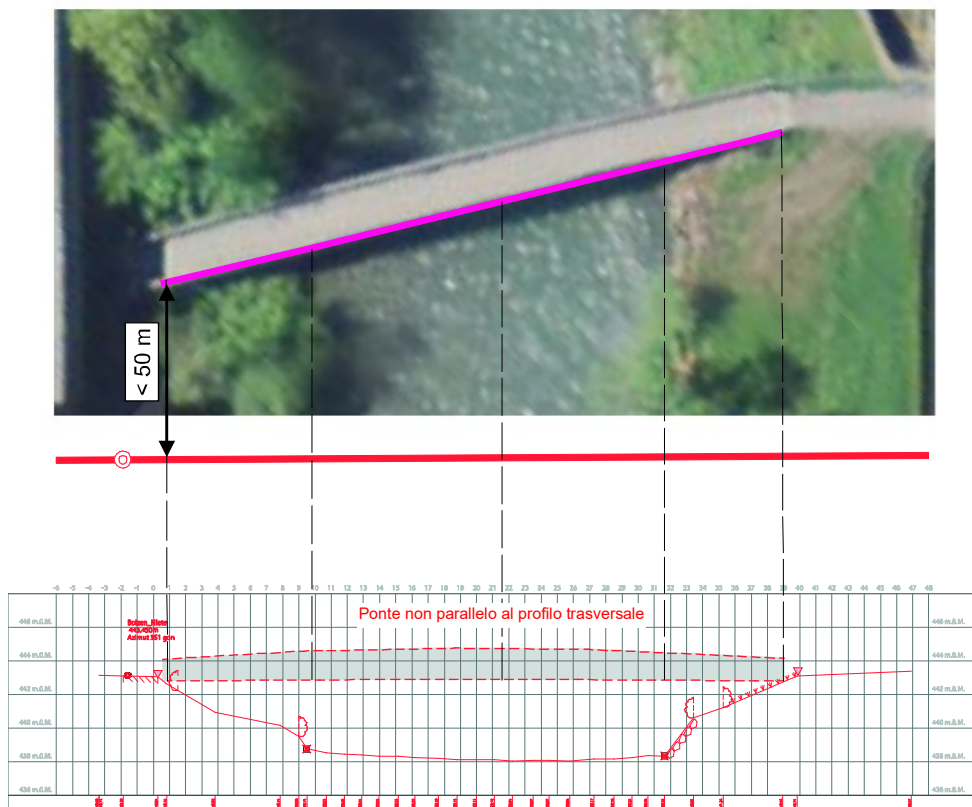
Proiezione di un ponte in un profilo trasversale distante meno di 50 m.
